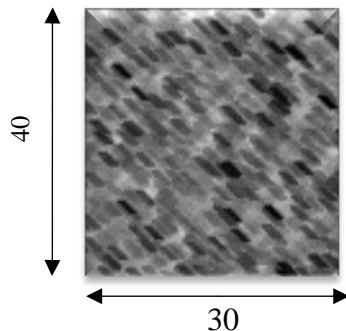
Section transversale de la poutre $30 \times 40 \text{ cm}^2$.
